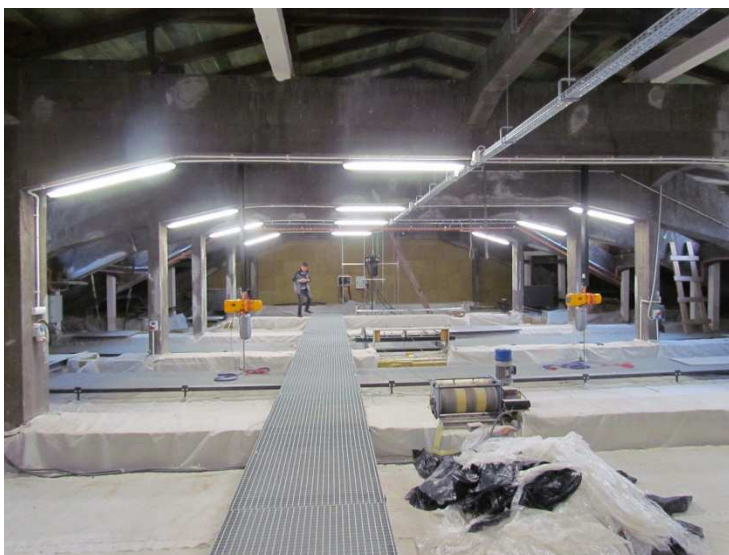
Odkrywka pasa dolnego dźwigara żelbetowego
